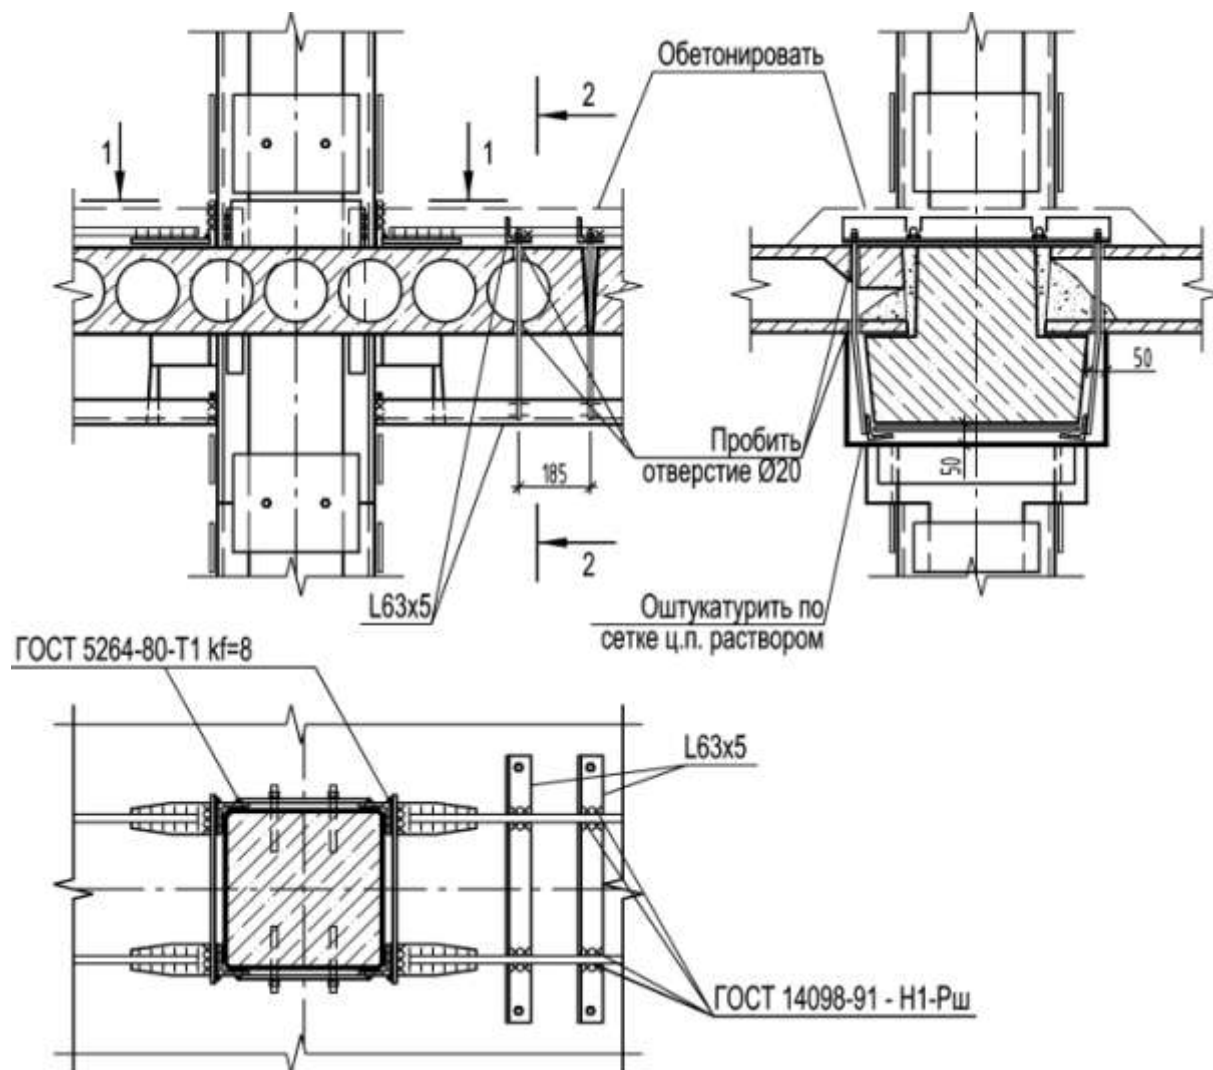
Узел поперечной рамы усиленный дополнительной арматурой
